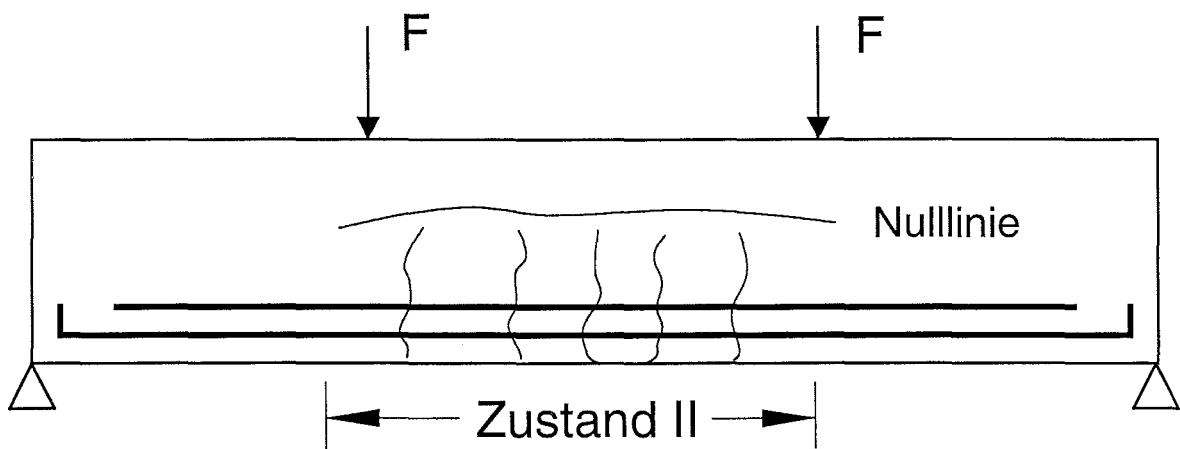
Biegezugrisse an einem Stahlbetonbalken im hochbeanspruchten Bereich
